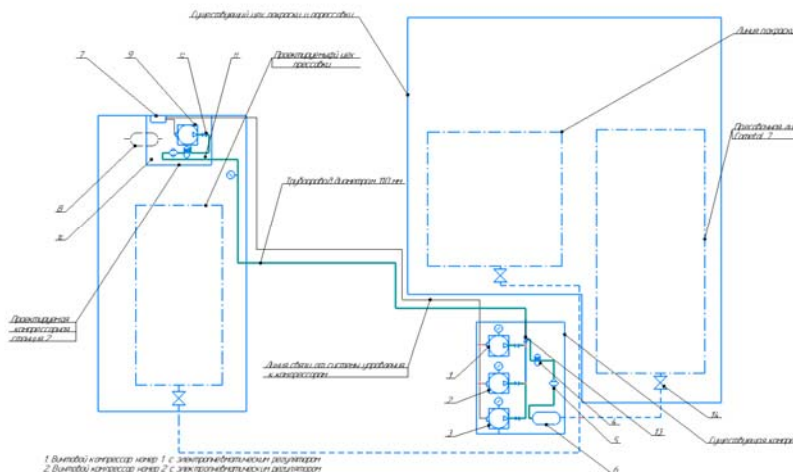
Схема расположения компрессоров в проектируемой и существующей компрессорной станциях
